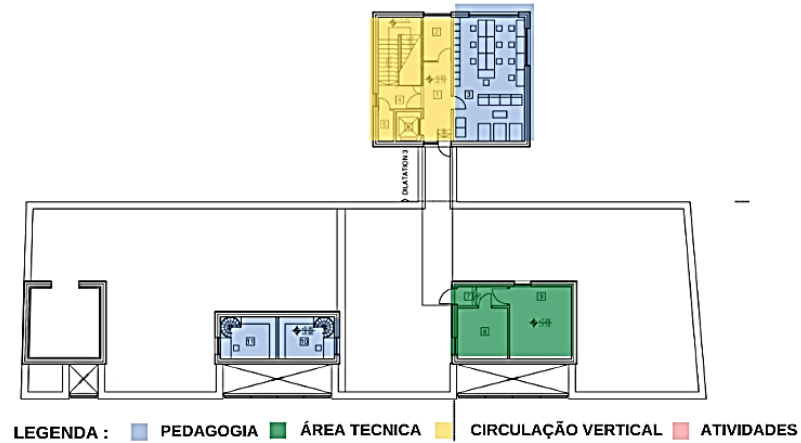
AUTISM CENTER OSIJEK – PRIMEIRO PAVIMENTO.
